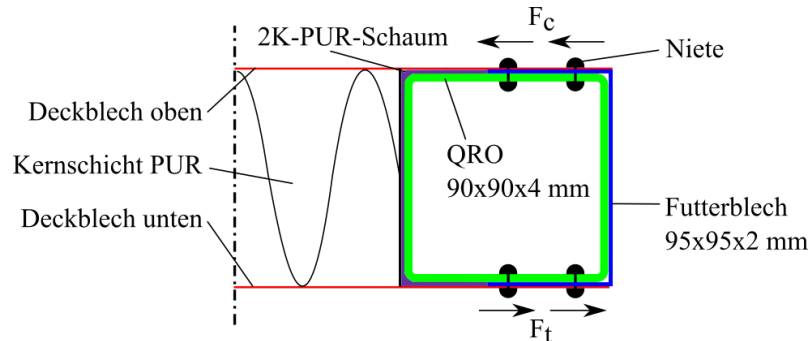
Anschluss Einschubling - Deckblech beim Typ 2 (Schnitt - schematisch)
